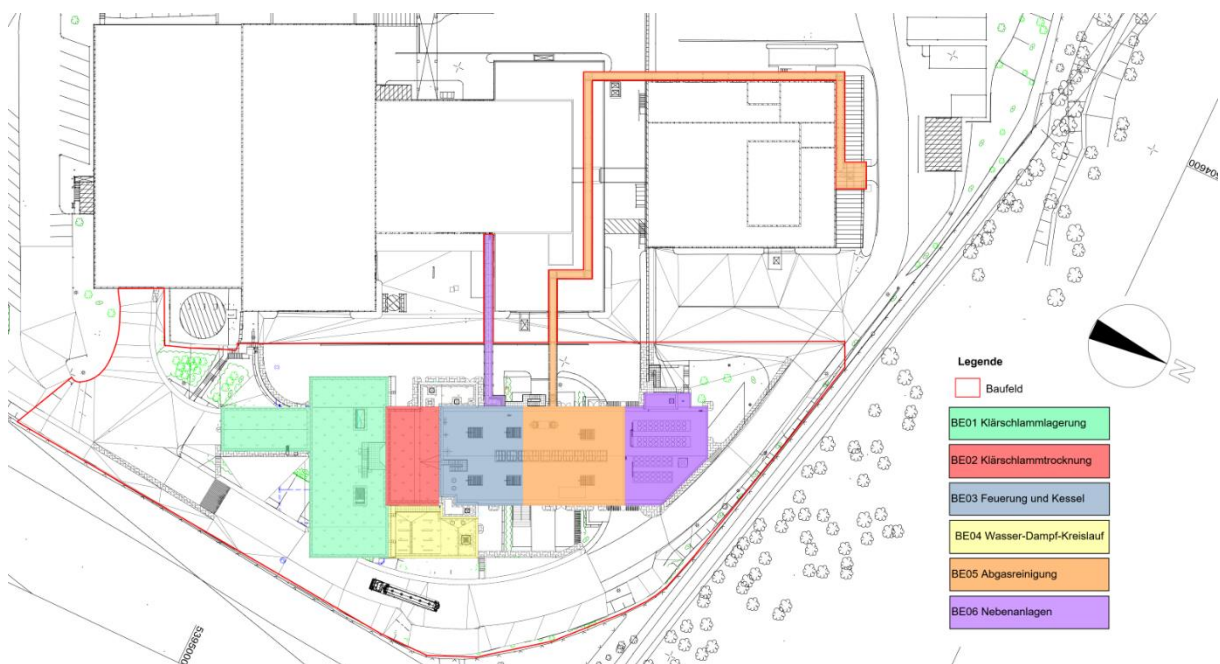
Lageplan mit Betriebseinheiten der neu zu errichtenden KSVA.
